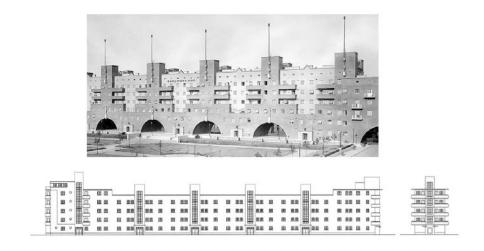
a.12. -Karl Ehn: Karl Marx-Hof. Alzado (Viena, 1927-1930). -Jesús Carrasco Muñoz: Viviendas para la Obra del Hogar Sindicalista. Alzado (Zamora, 1939).
